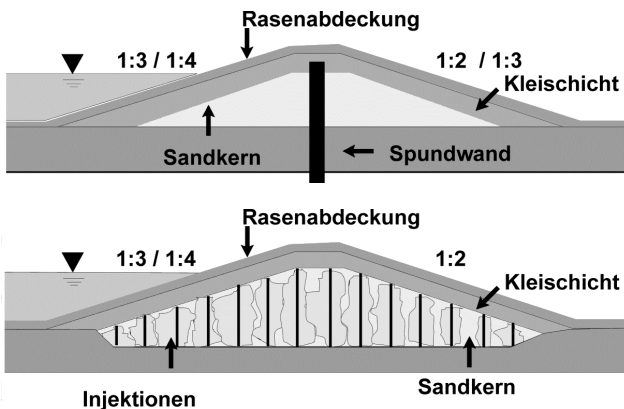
Untersuchungsvarianten mit konstruktiven Verstärkungen, die nachträglich eingebaut werden können
